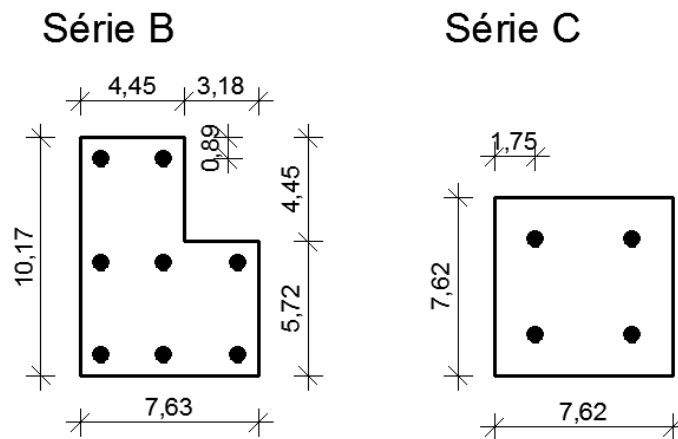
Disposições das armaduras dos pilares de Tsao (1992).
